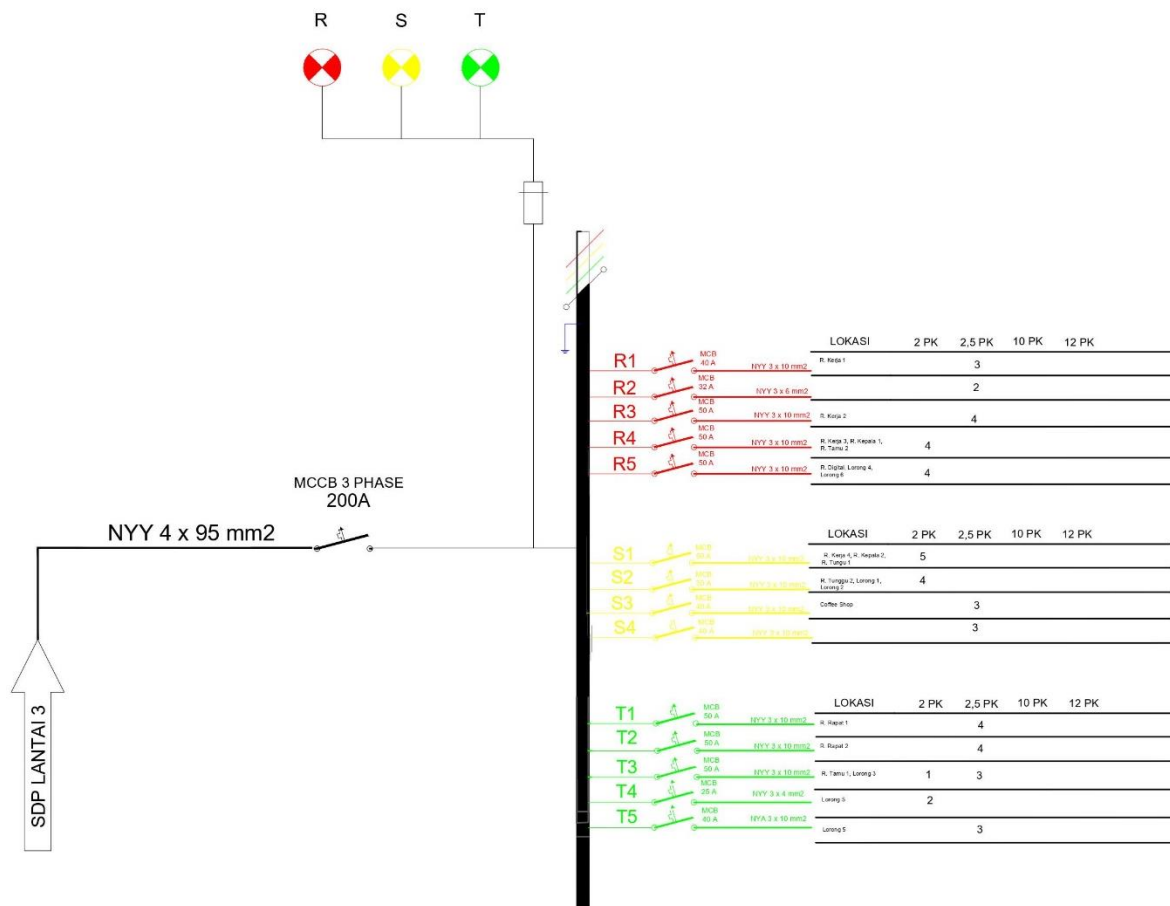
Panel lampu lantai 3 Gedung Kantor Sewa
